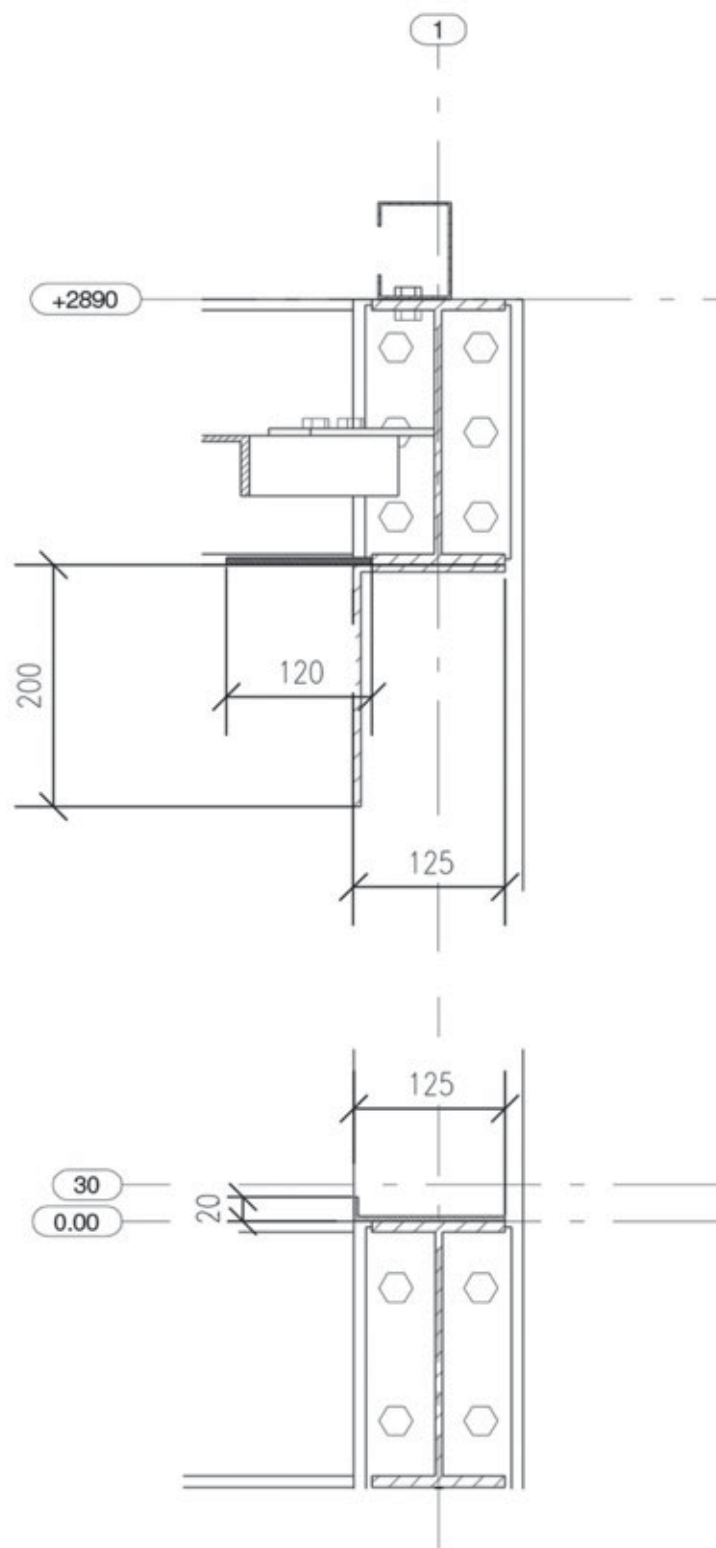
| Sezioni di dettaglio della carpenteria metallica in corrispondenza dei nodi Trave-Copertura (in alto) e trave-solaio (in basso).
